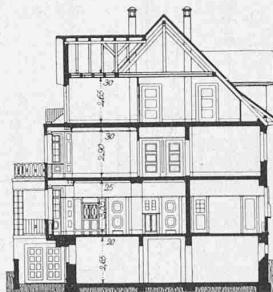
bis 6. Grundrisse und Schnitt des Hauses zum «Blumenegg». — Maßstab 1:400
